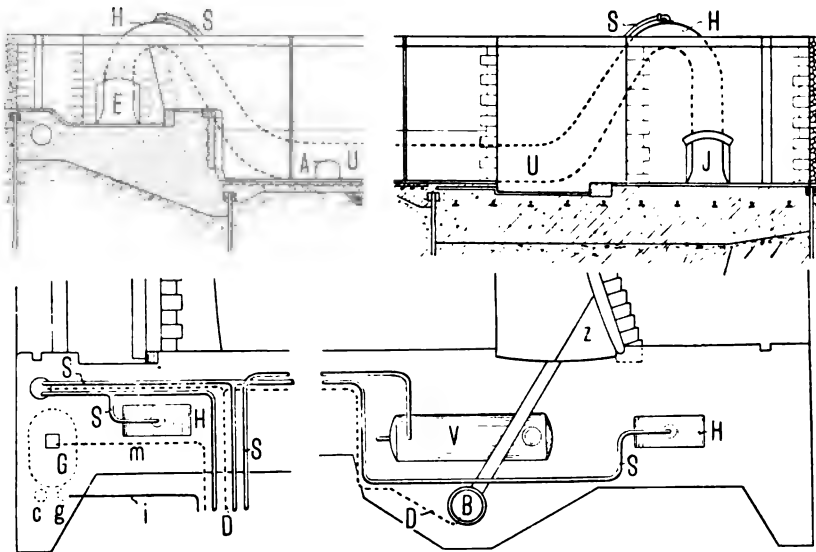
Die Hotoppschleuse im Längenschnitt und Grundriß.
